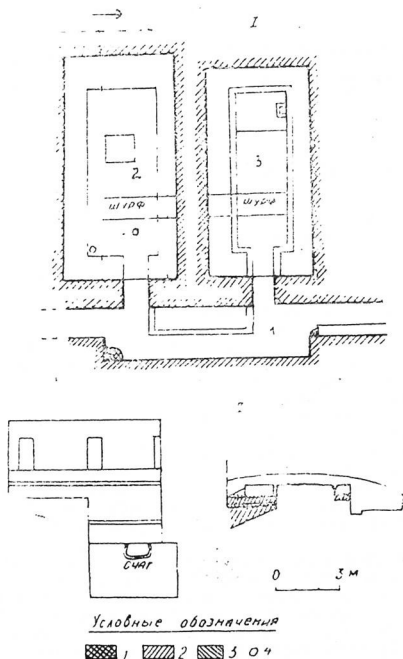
Байтудашт IV. План храма II. План и размер оборонительной стены. Условные обозна-
